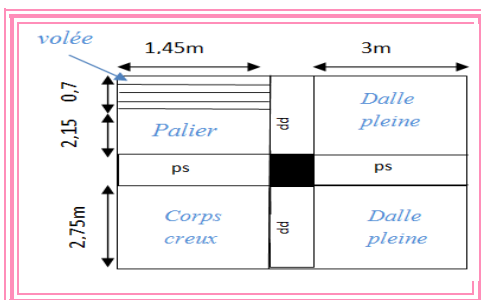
la surface afférente du poteau « C4 » pour l'étage 1 et RDC.
